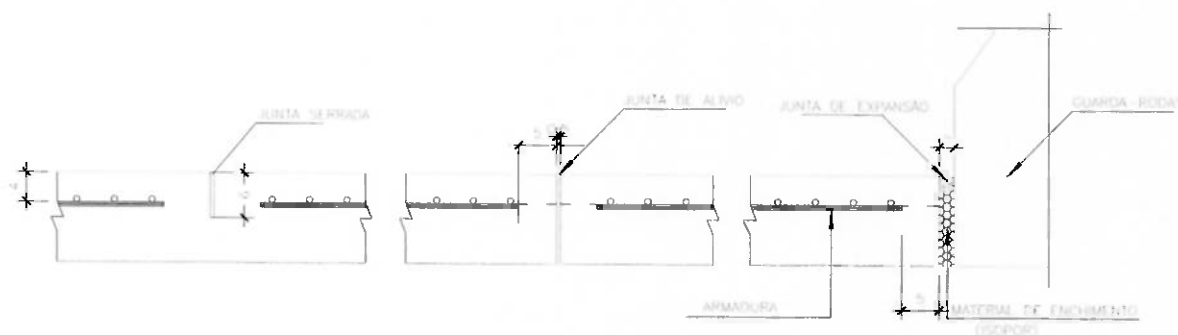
Juntas transversais (serradas e de alívio) e longitudinais (de expansão)
